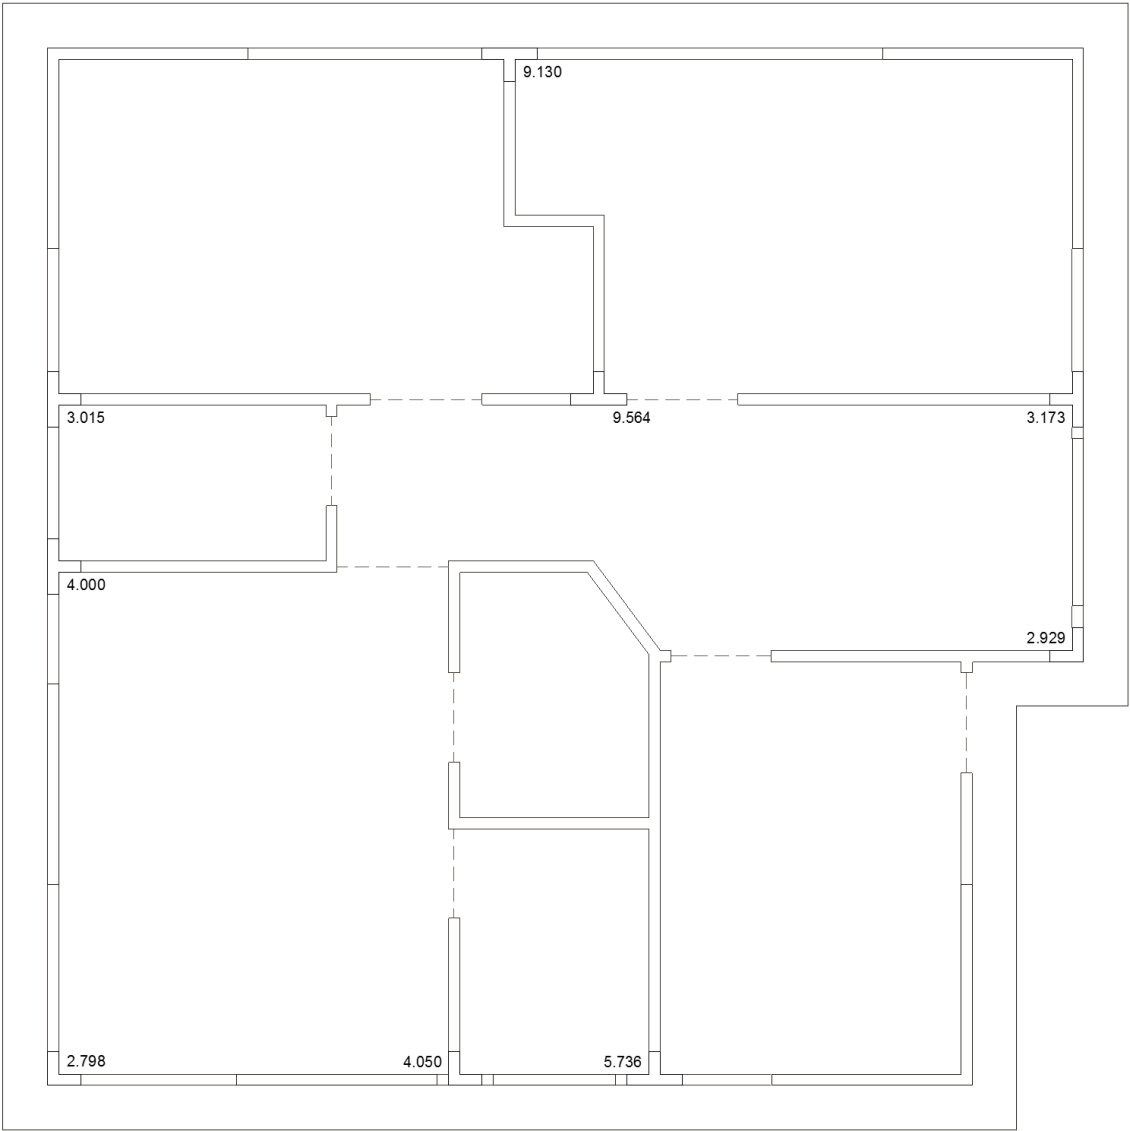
Flujo de cargas en seudo columnas en losa N+2.70m
